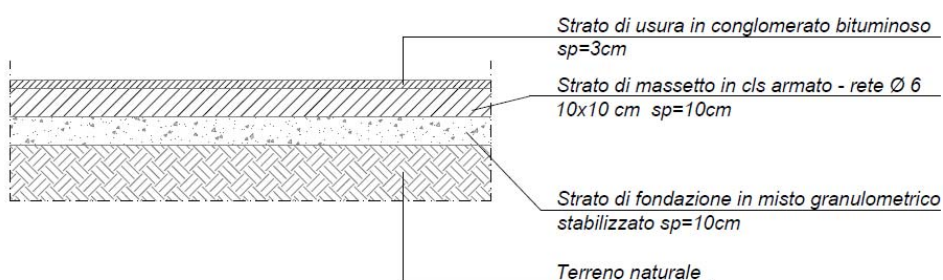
Pacchetto pavimentazione stradale asse A, asse B e rotatorie
